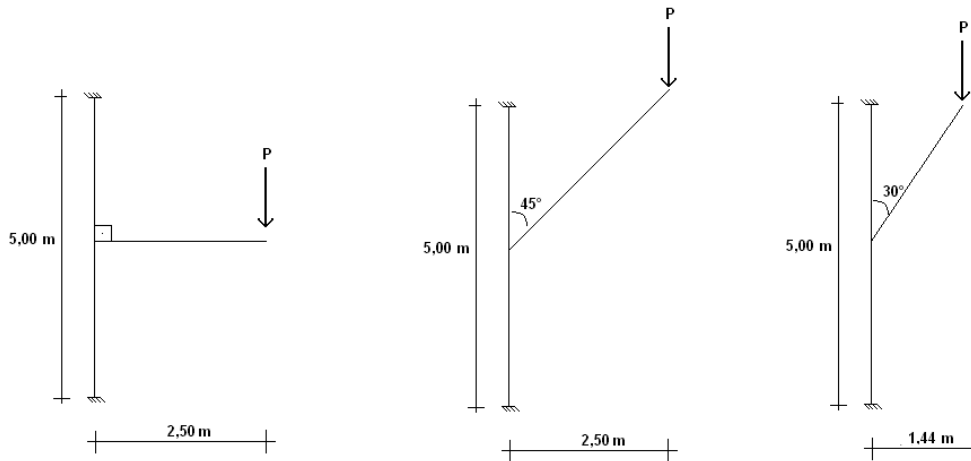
Esquema estrutural das juntas T e Y em elementos de pórtico espacial
